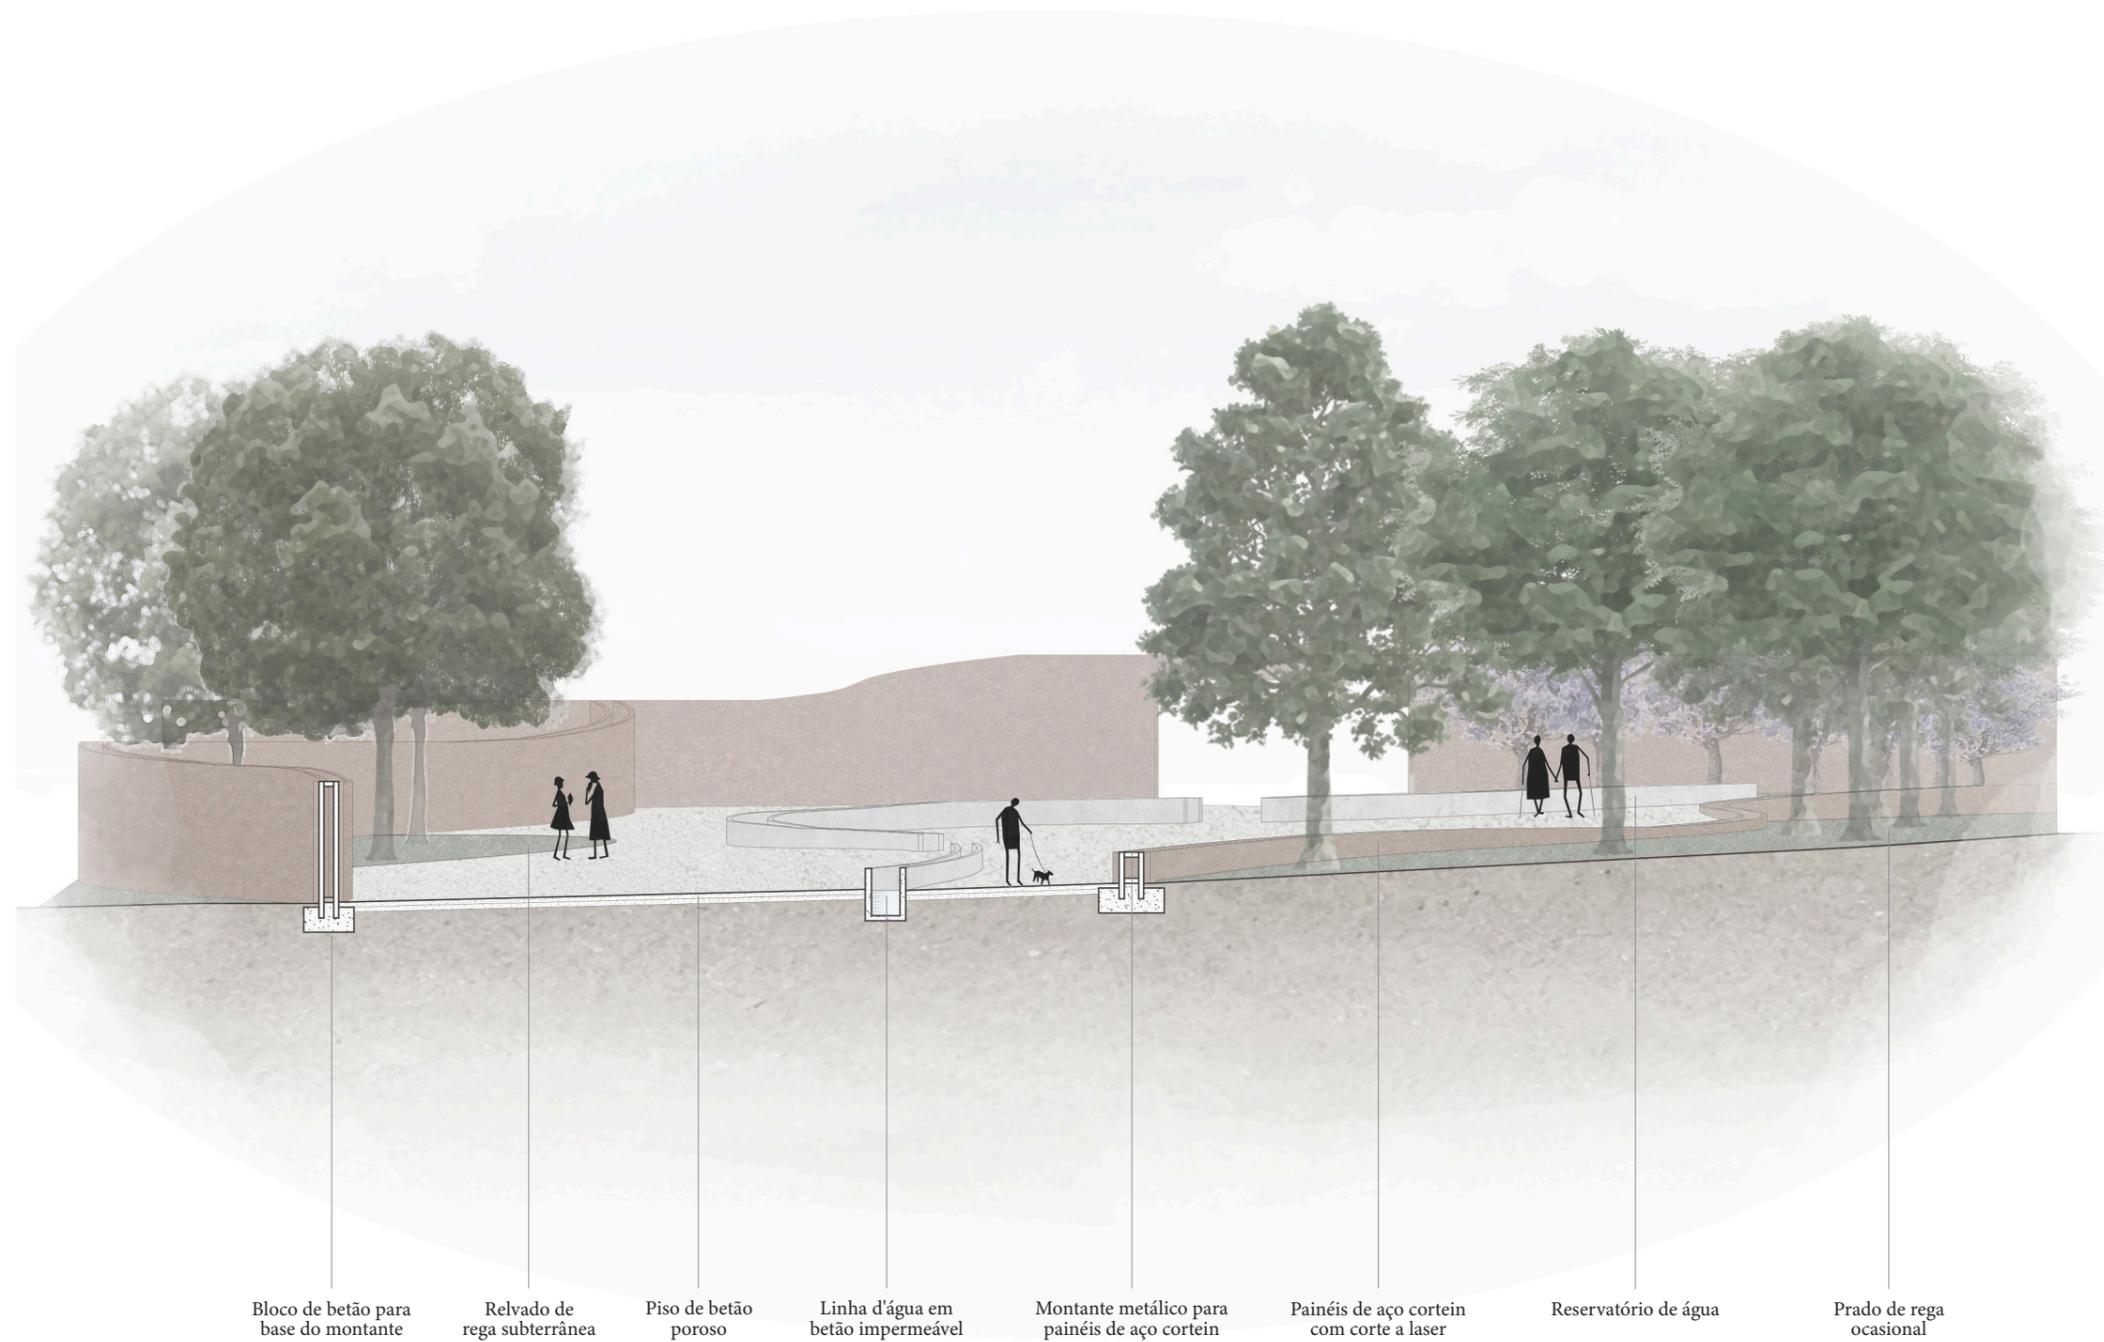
Detalhes do corte construtivo da praça. Escala 1:140.
